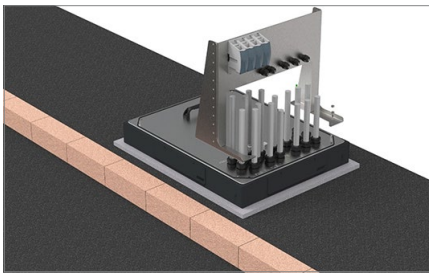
Aufsetzen Einstelllehre und Fixierung an Einpressbolzen und mittels Sechskantschraube.
